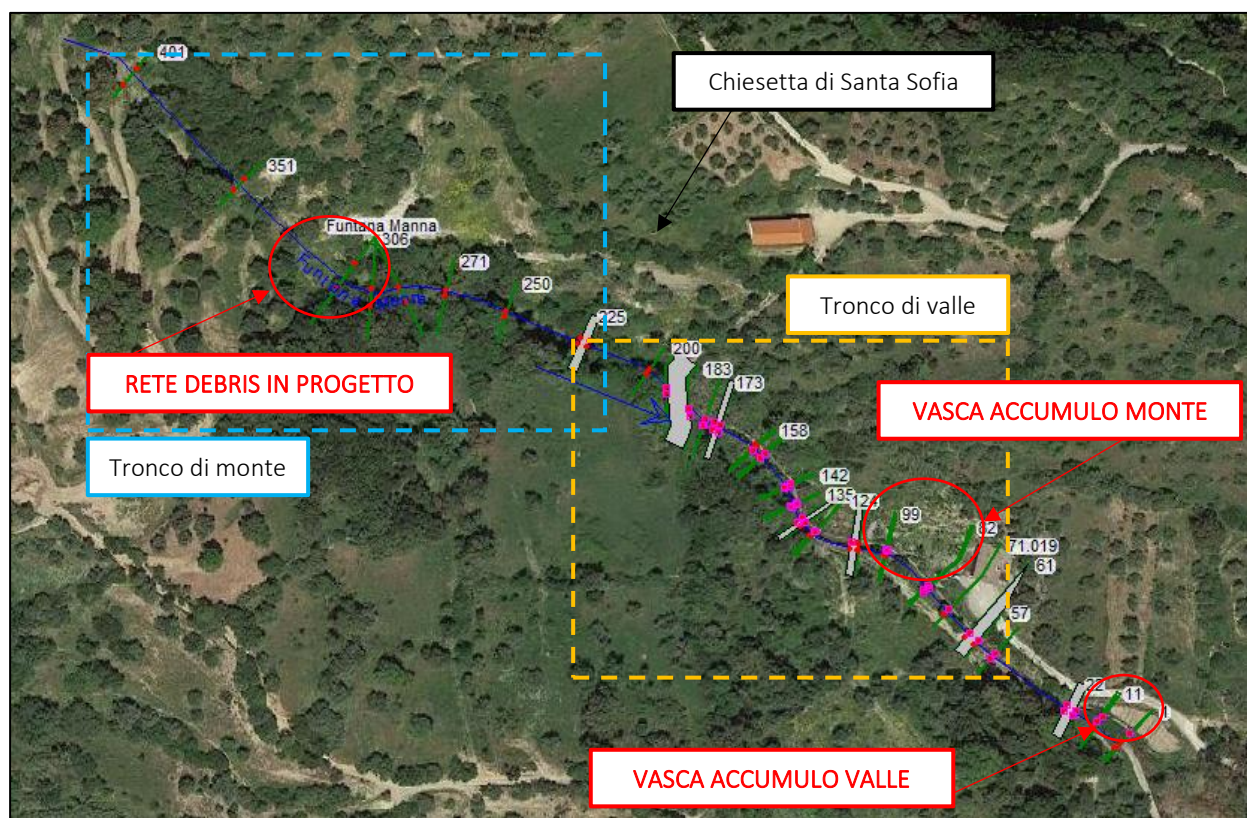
Planimetria di ubicazione delle sezioni di calcolo e degli interventi in progetto.
